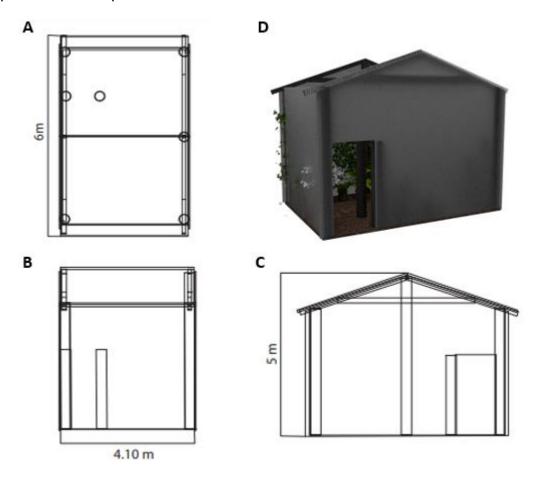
Planos del mariposario. A) Vista superior, B) Vista frontal, C) Vista lateral, D) Render vista exterior. (Autor)
